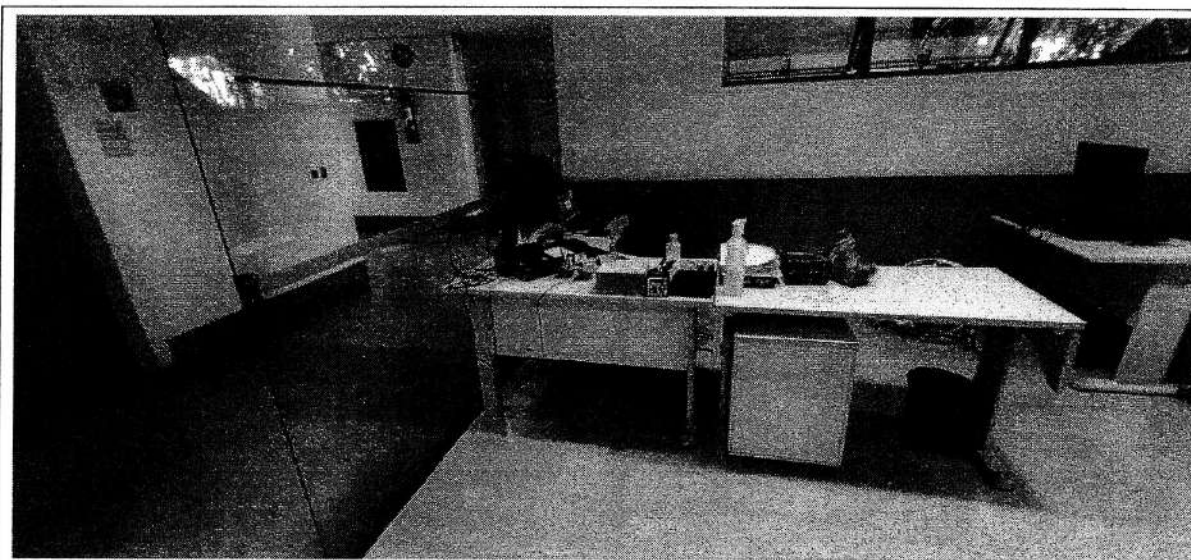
3º pavimento – Biblioteca – não possui mobiliário acessível
